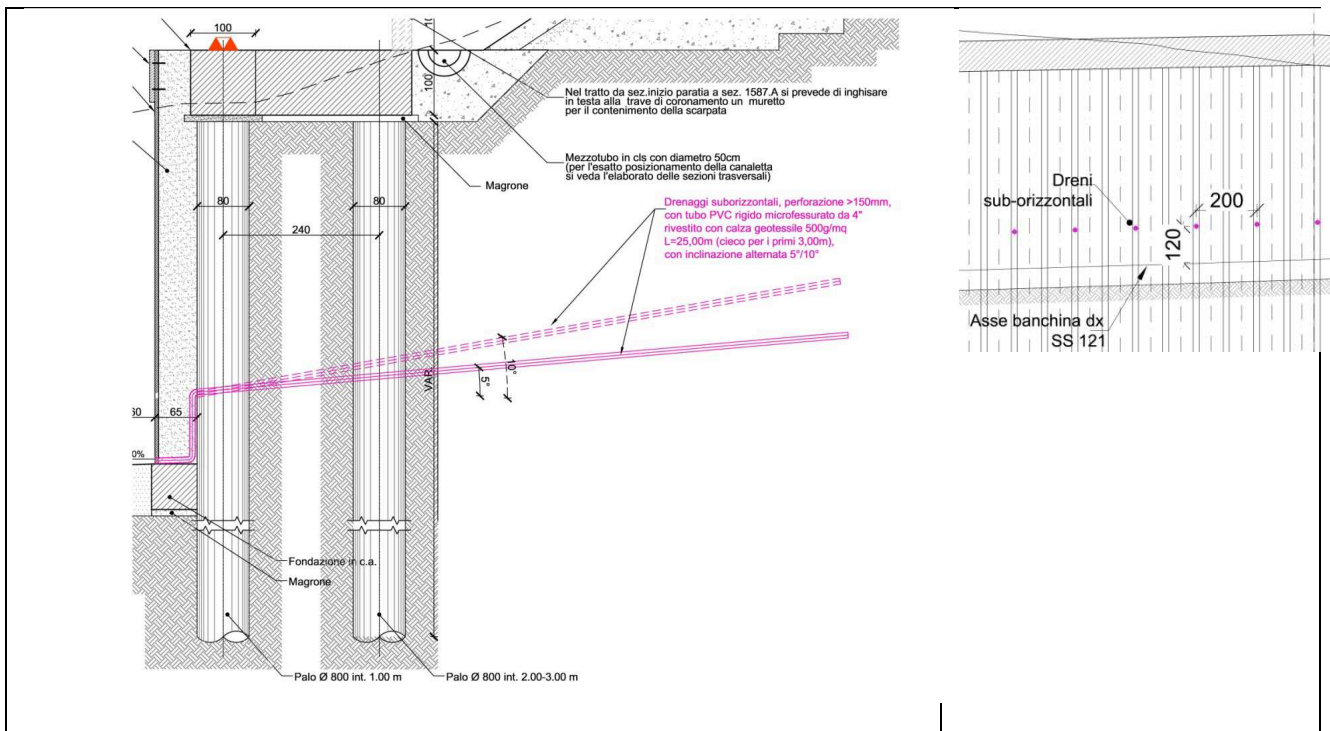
Sezione tipo e stralci di prospetto proposta di inserimento dreni sub-orizzontali
